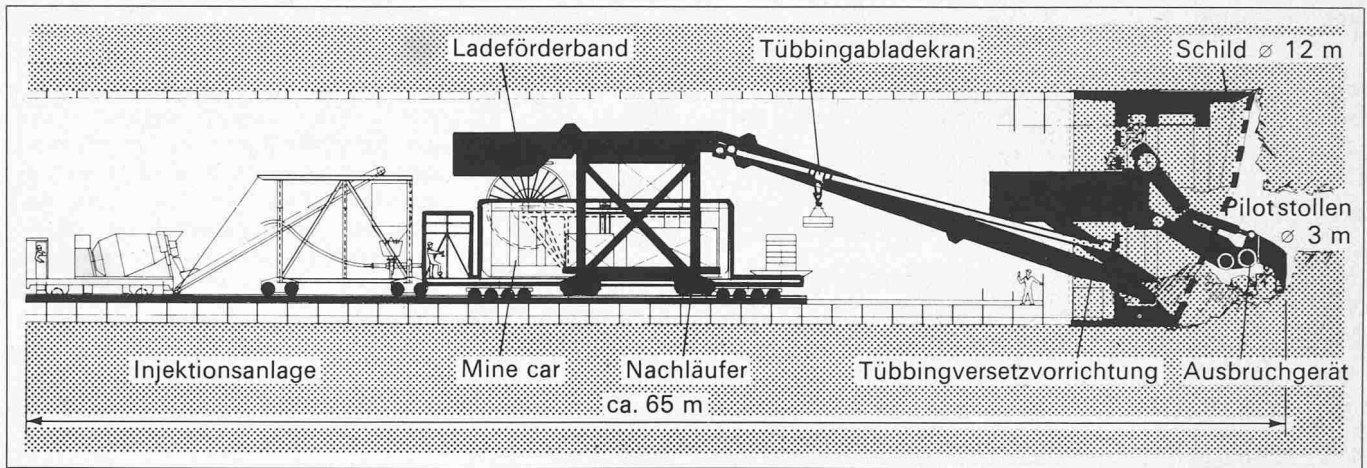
Tunnelbauausrüstung Memco Los Huttegg
